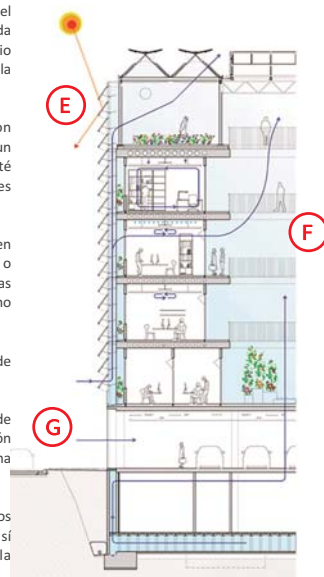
Corte por fachada C. de I. de la U.A.B.
